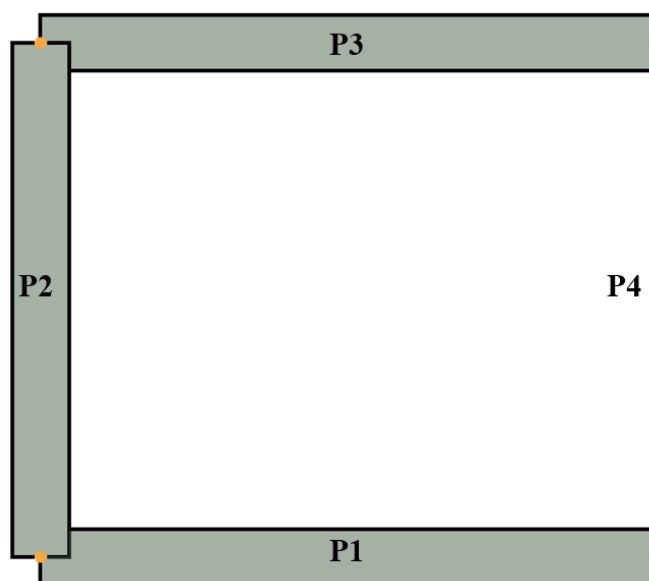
Pianta con indicazione delle pareti - Modello Isolato
